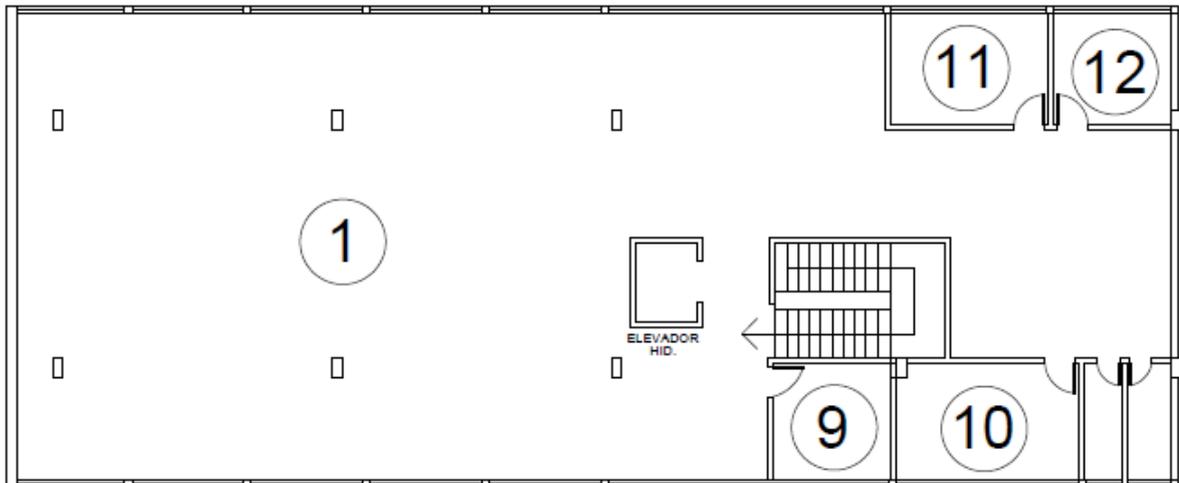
Layout Pavimento superior (Sala de pesquisa)
